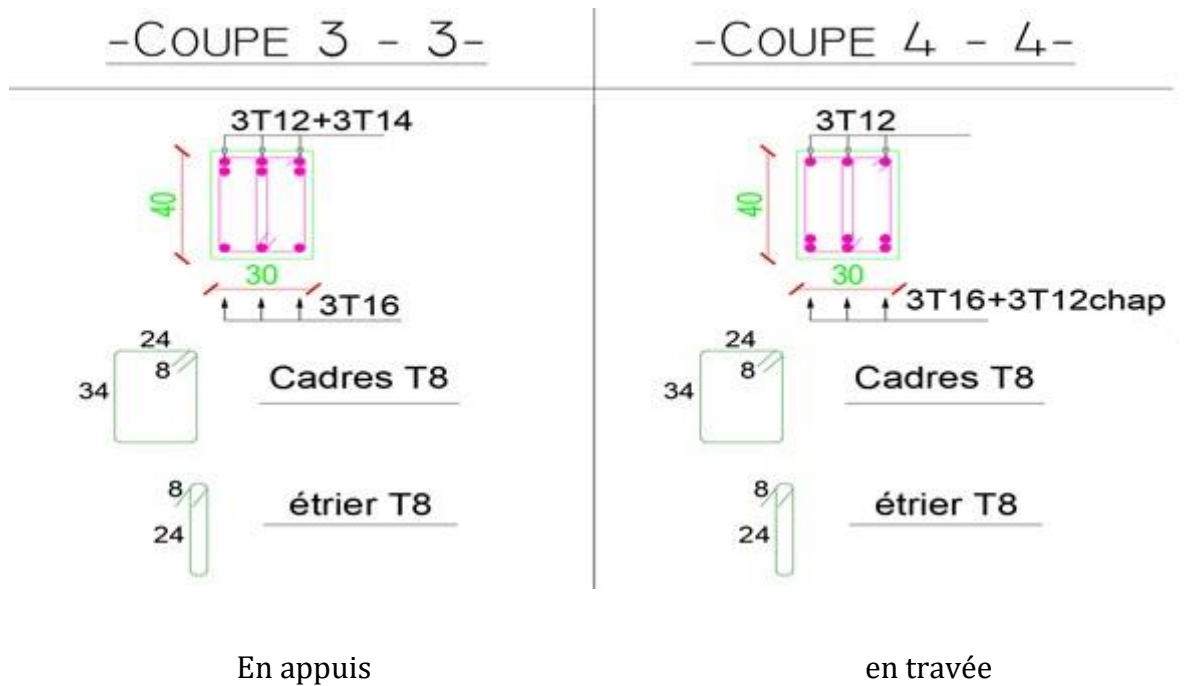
Schéma Ferrailage des poutres principales (30x40)
